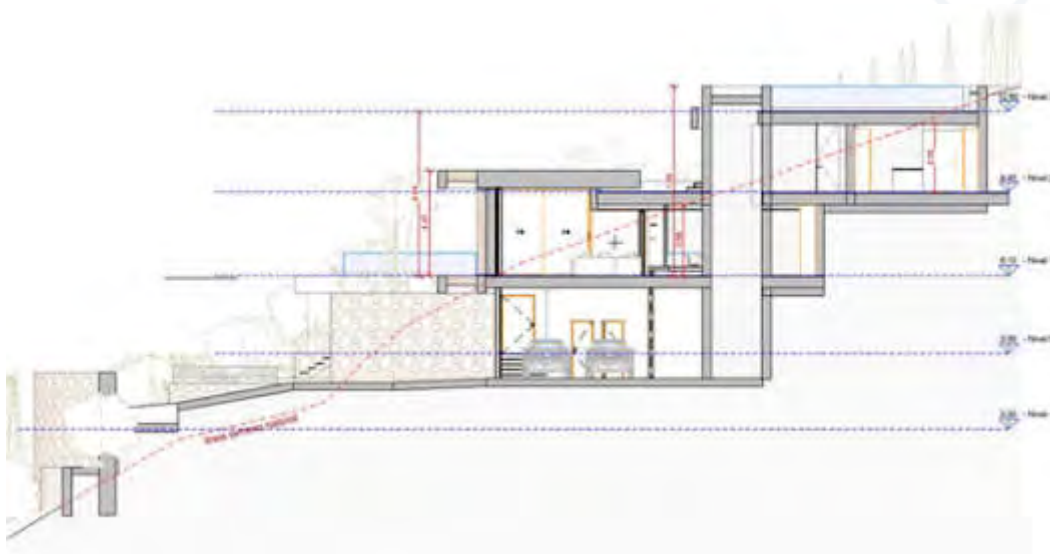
SECCIÓN TRANSVERSAL POR ASCENSOR
